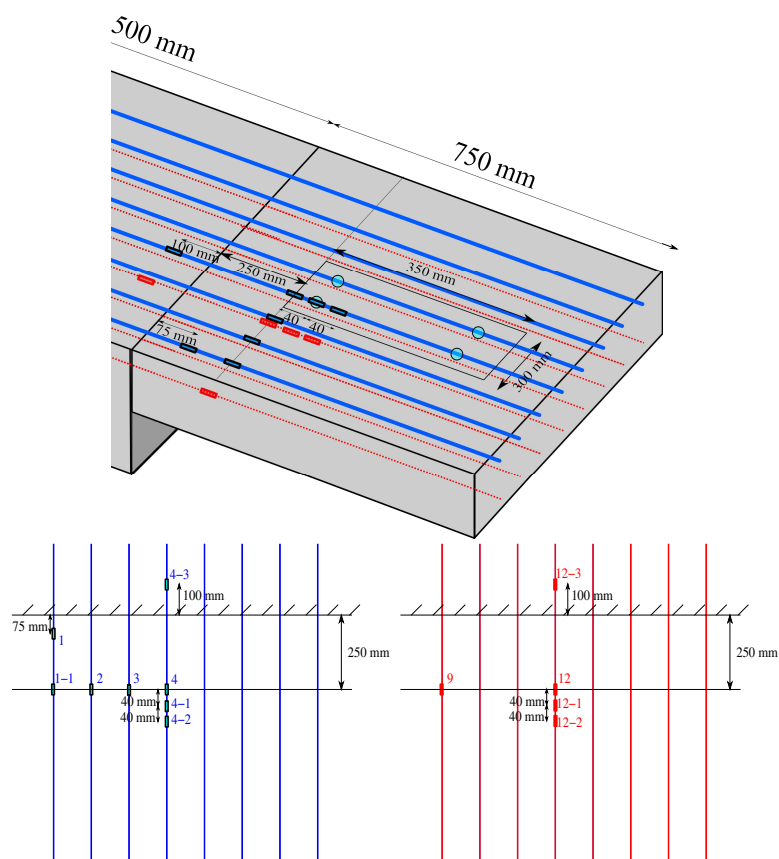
Position des jauges de déformation sur les armatures de la dalle 4
